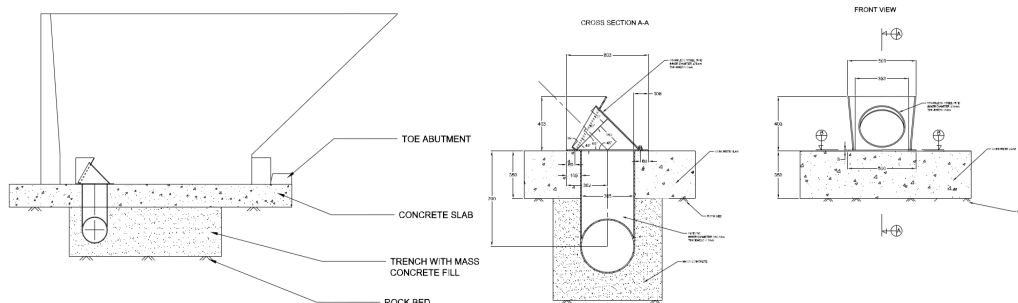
Déflecteur sur hausse principale (puits non dessiné) et canalisation d'admission
